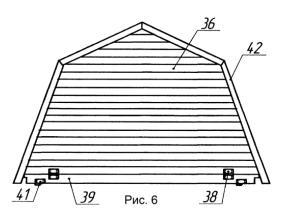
Изображен фронтон мансардной крыши с поперечной балкой:36-фронтон; 38-шарнир; 39-поперечная балка; 41-полушарнир; 42-соединительный борт.
